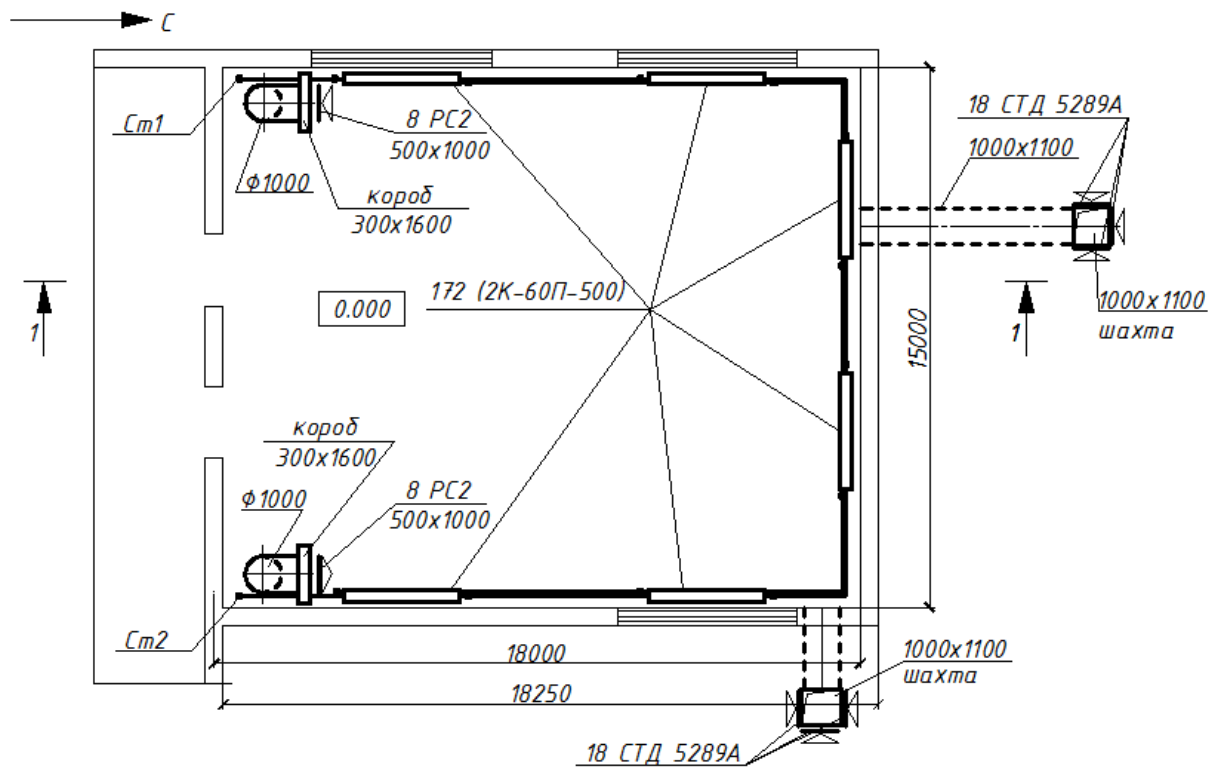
План актового зала с нанесением отопительно-вентиляционного оборудования
